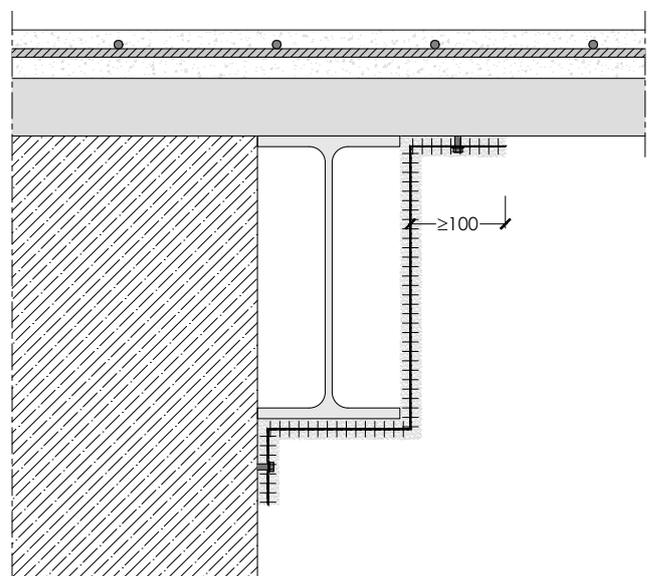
Schema di applicazione per protezione di trave di bordo in carpenteria metallica, posizionata in corrispondenza di muratura resistente al fuoco. (applicazione a box)
